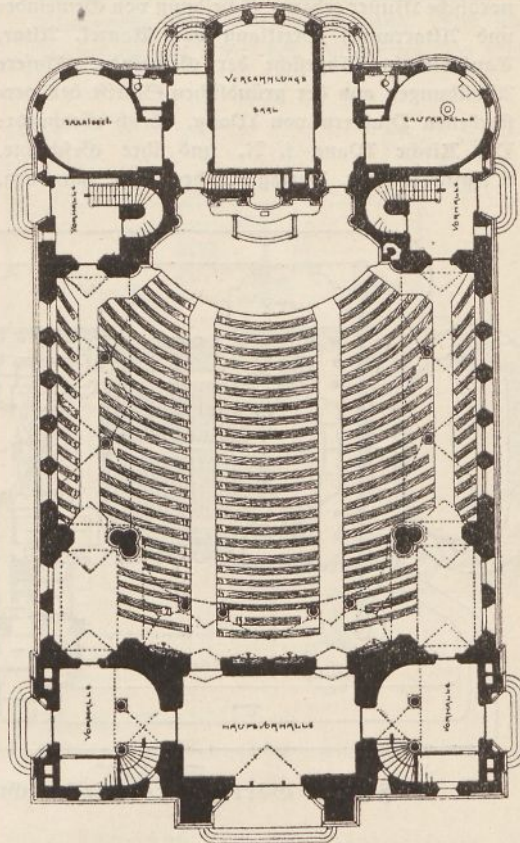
Breslau, Erlöserkirche, Grundriß.
